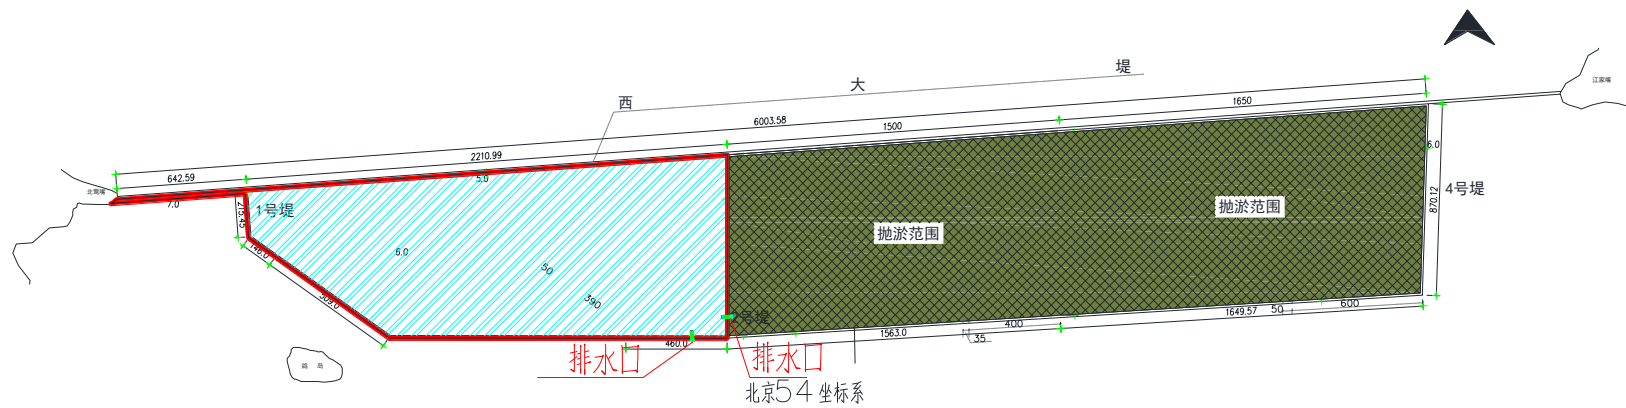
西大堤南侧集装箱吹填区平面布置图
